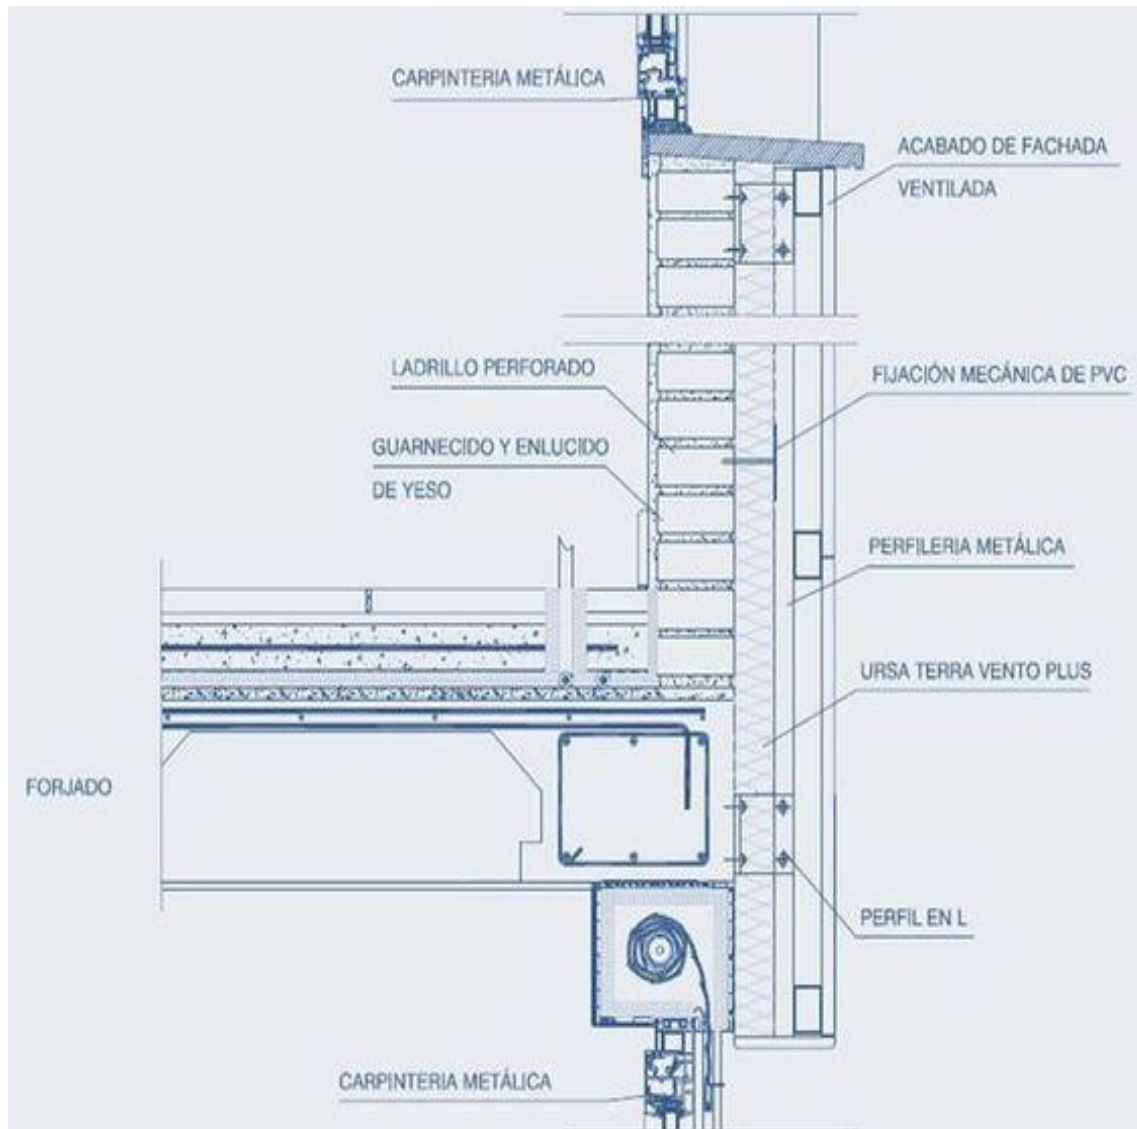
Exemplo de detalhe de construção. Fachada ventilada tradicional (S01).
